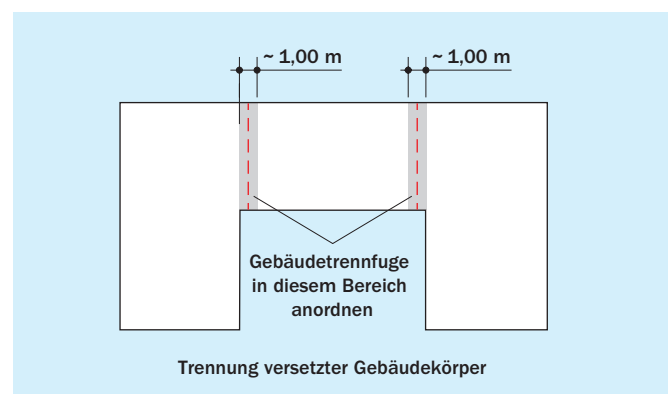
Trennung versetzter Gebäudekörper mit Gebäudetrennfugen
